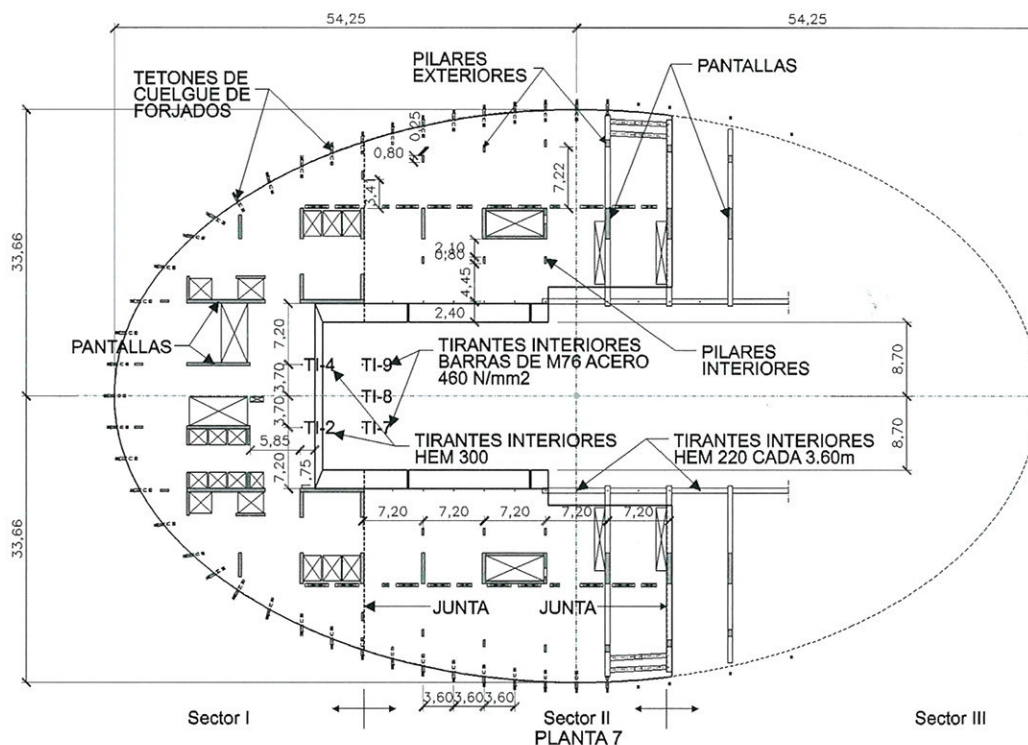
Planta 7. Forjado elíptico de semieje mayor 54,25 m y 33,66 m de semieje menor.
